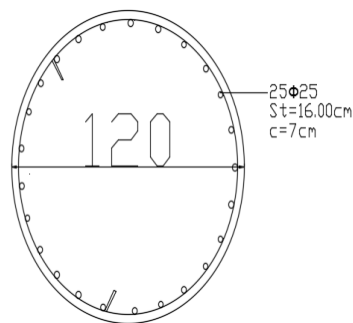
Schéma de ferrailage longitudinal d'une rangée de pieux
